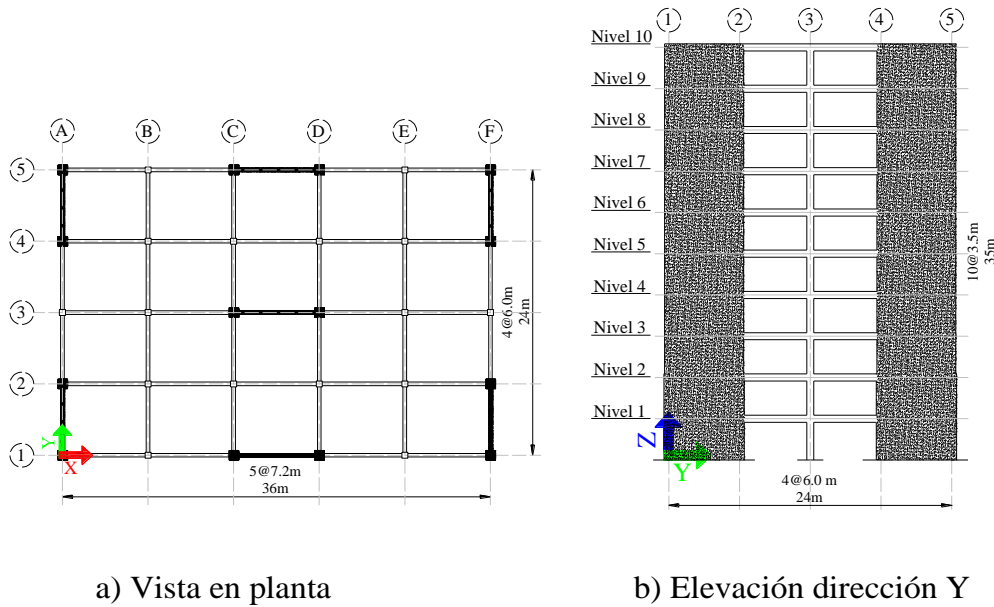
Vista en planta y elevación de eje A del edificio
